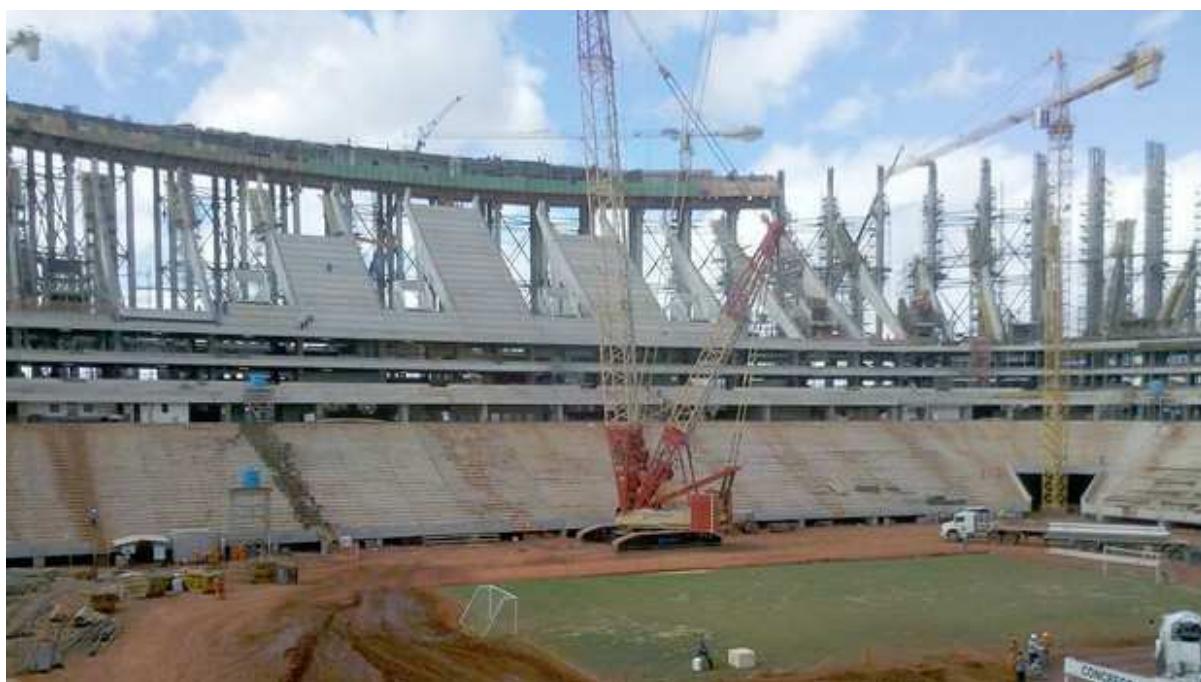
Estádio Nacional de Brasília durante construção (LIMA, 2013)
